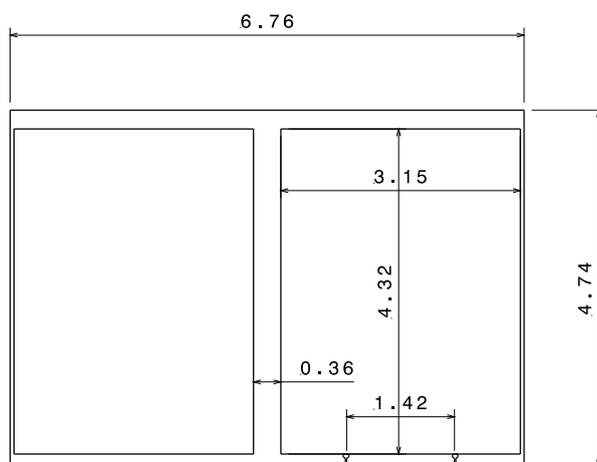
Gabarit ferroviaire pour les deux voies (unité : mètre)
